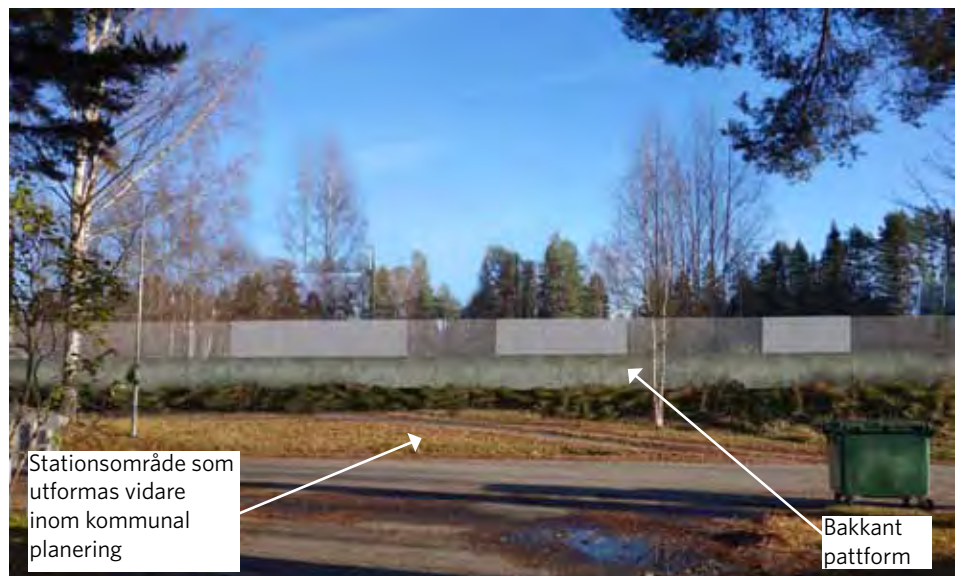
Järnvägssektionen visar bullerskärmens placering i bakkant av plattformen vid Njurundabommen.
